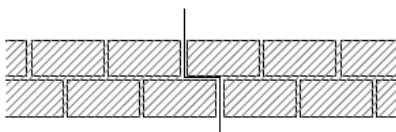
Junta de movimiento con solape. Esquema en planta
